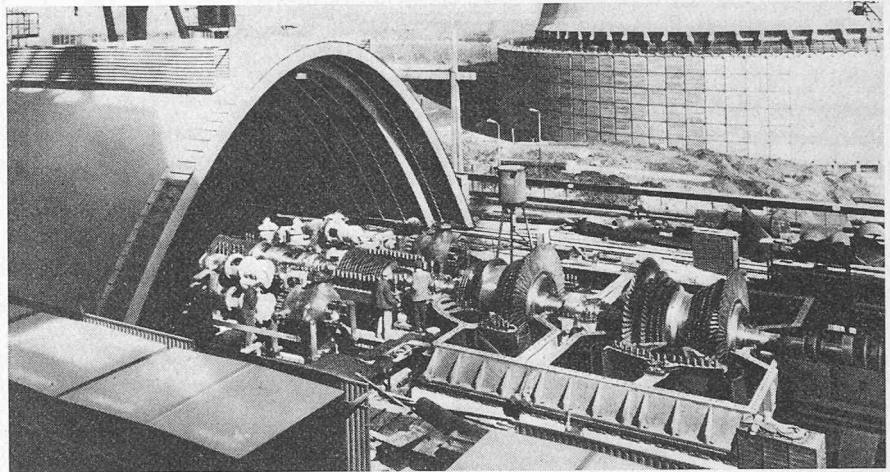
Turbine in Halbfreiluftaufstellung in Gyöngyös. Der Portalkran fährt über dem verschiebbaren Turbinenschutzdach. Unter dem Betonboden sind alle Anlagenteile im Gebäude untergebracht. Im Hintergrund befinden sich die Kühlelemente der Trockenkühltürme
